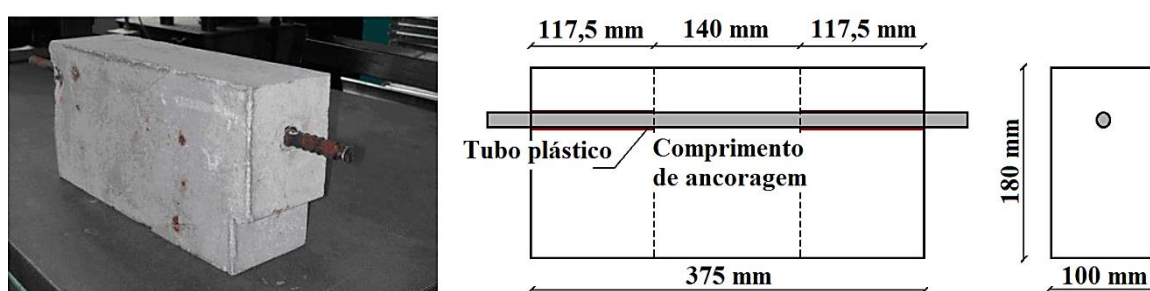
Vista geral e detalhes da geometria dos corpos de prova - Valente (2012).
